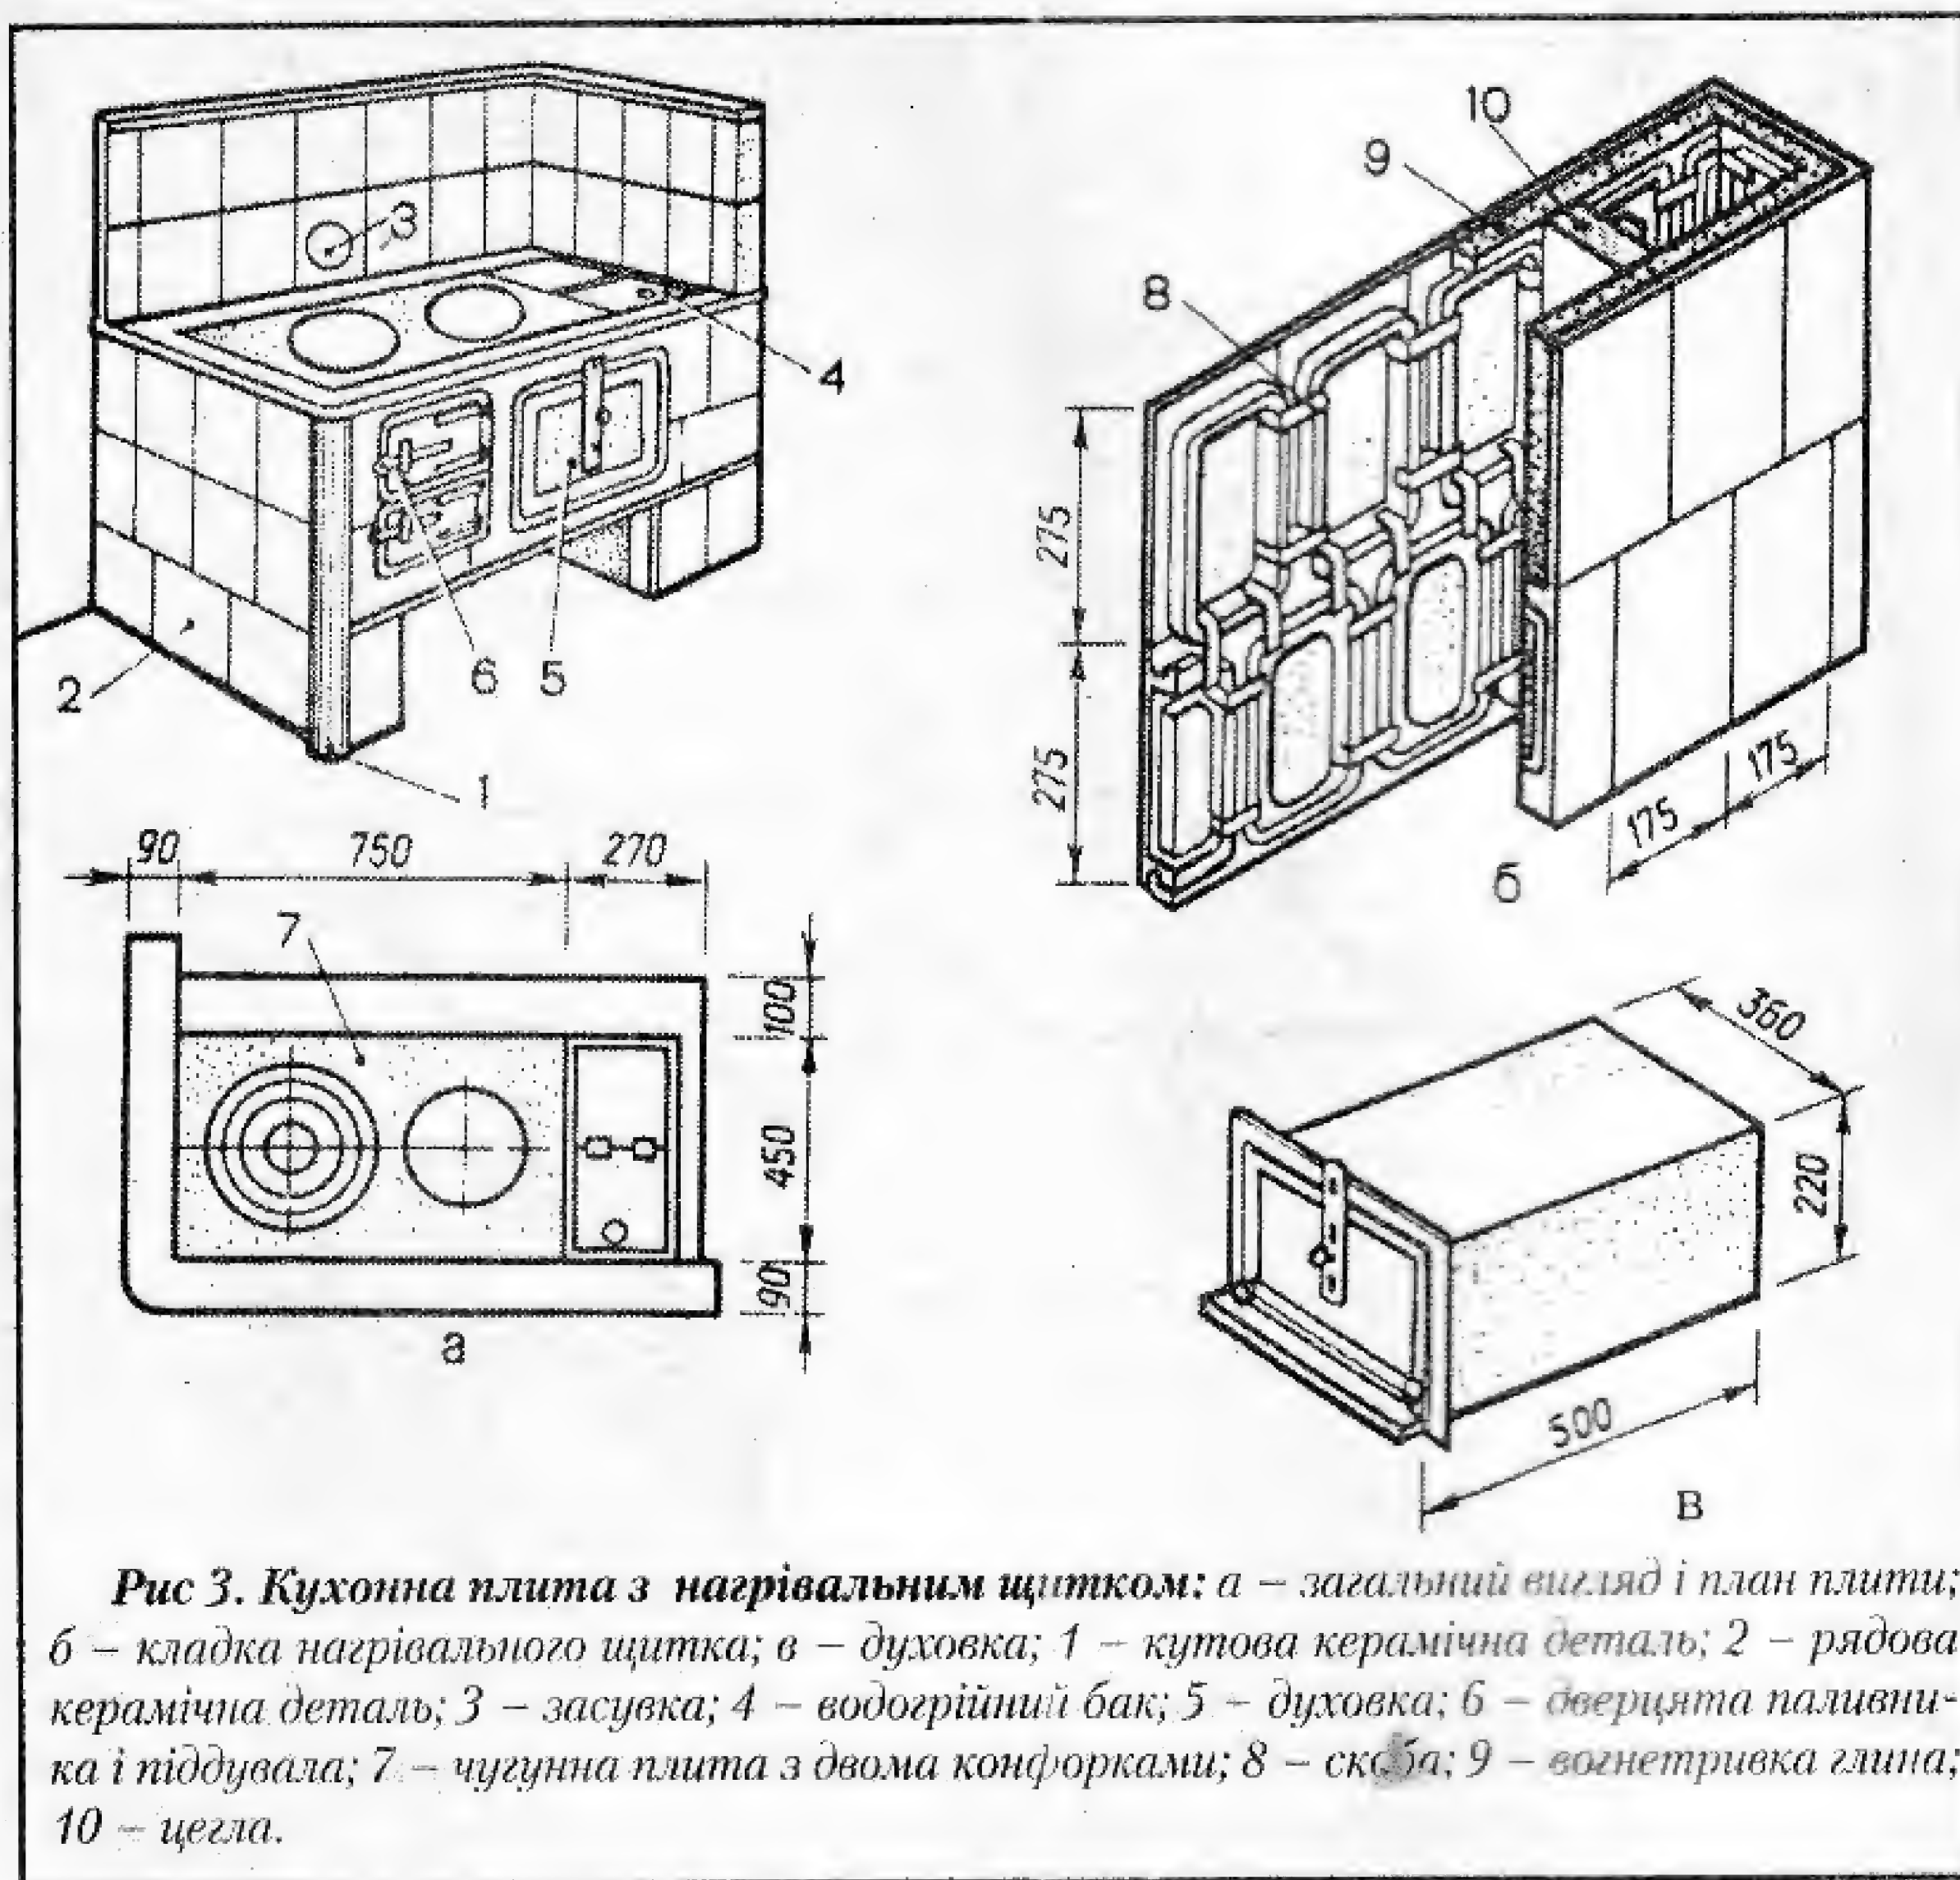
Кухонна плита з нагрівальним щитком: а – загальний вигляд і план плити; б – кладка нагрівального щитка; в – духовка; 1 – кутова керамічна деталь; 2 – рядова керамічна деталь; 3 – засувка; 4 – водогрійний бак; 5 – духовка; 6 – дверцята паливника і піддувала; 7 – чугунна плита з двома конфорками; 8 – скляка; 9 – вогнетривка глина; 10 – цегла.
